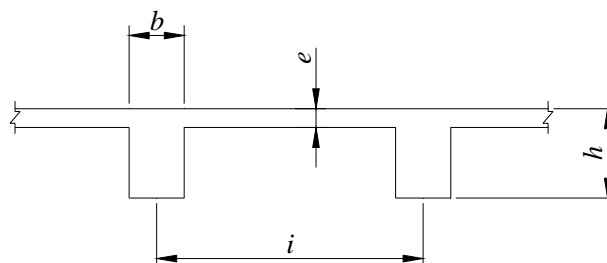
Seção transversal da laje com nervuras pré-moldadas.
